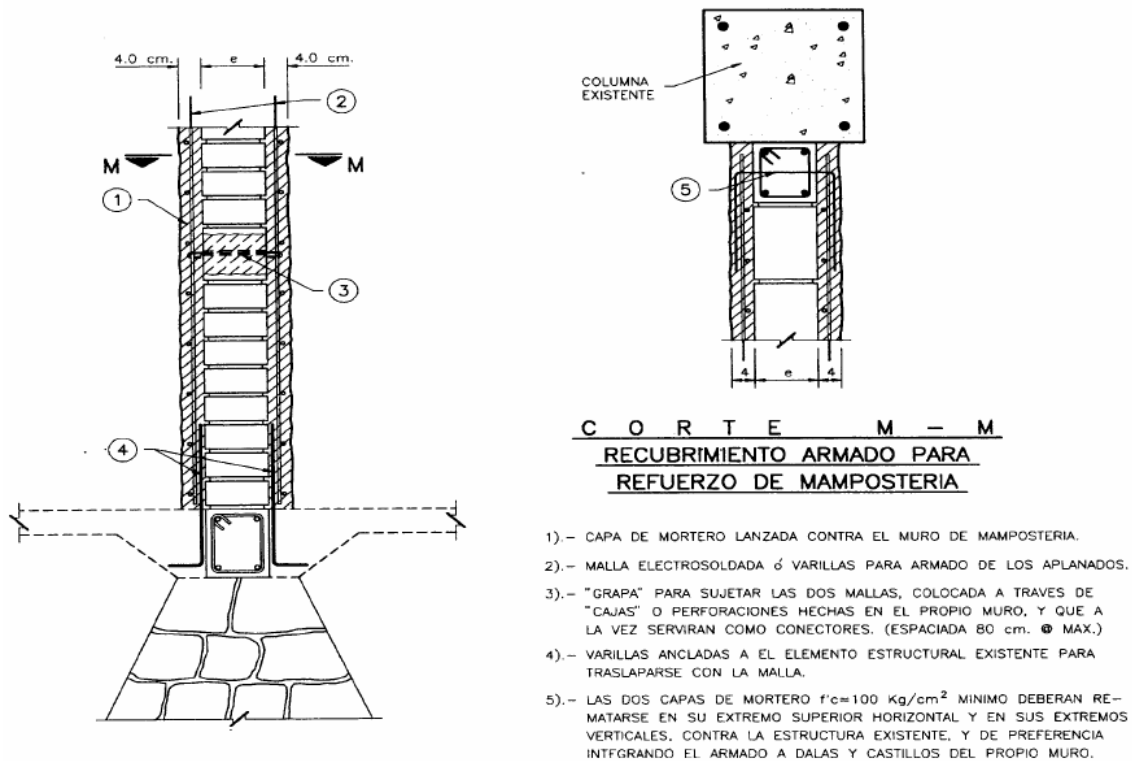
Recubrimiento armado para rehabilitación de mampostería (de la Torre, 1995).
